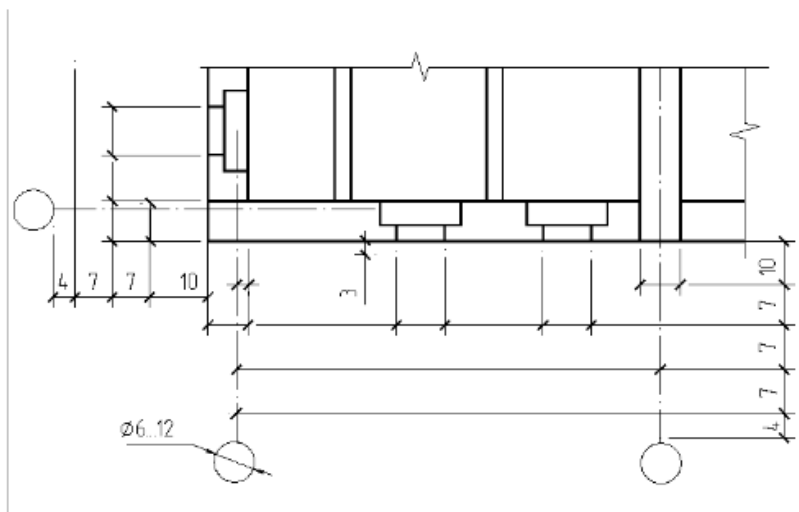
Пример нанесение размерных линий на фрагменте плана здания
